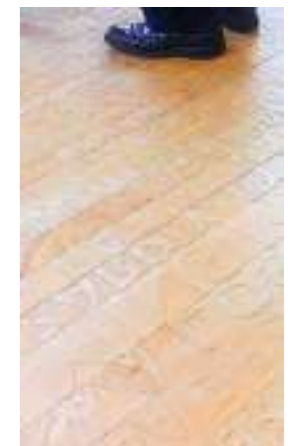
Pavimento da Sala de Crianças (Piso 1).
